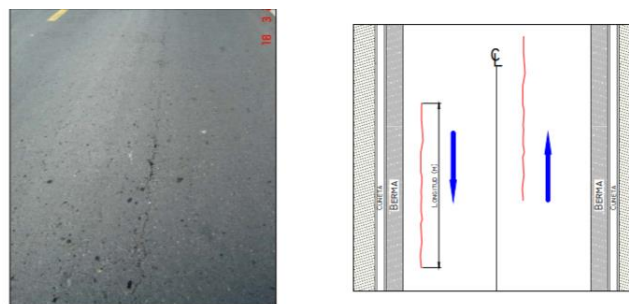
Fisura longitudinal (FL, Unidad de medida: m).
